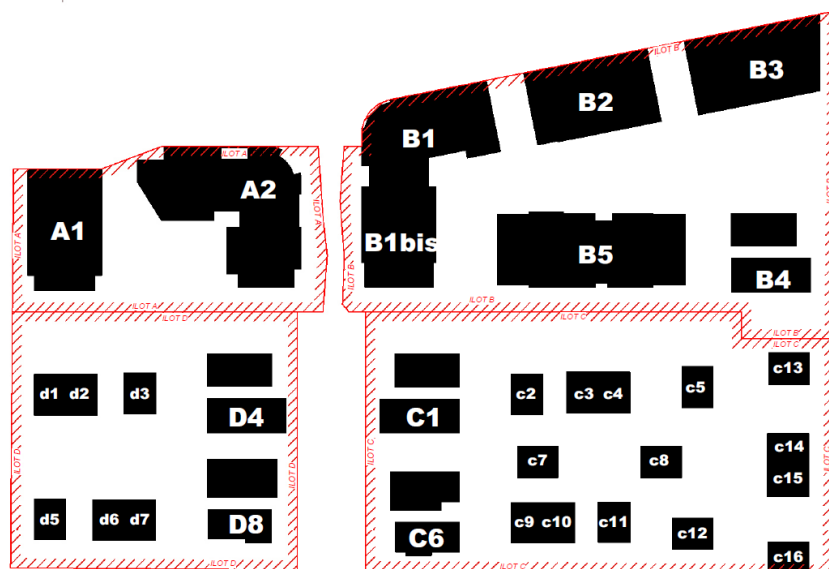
Plan des bâtiments – (Source A26 BLM)
